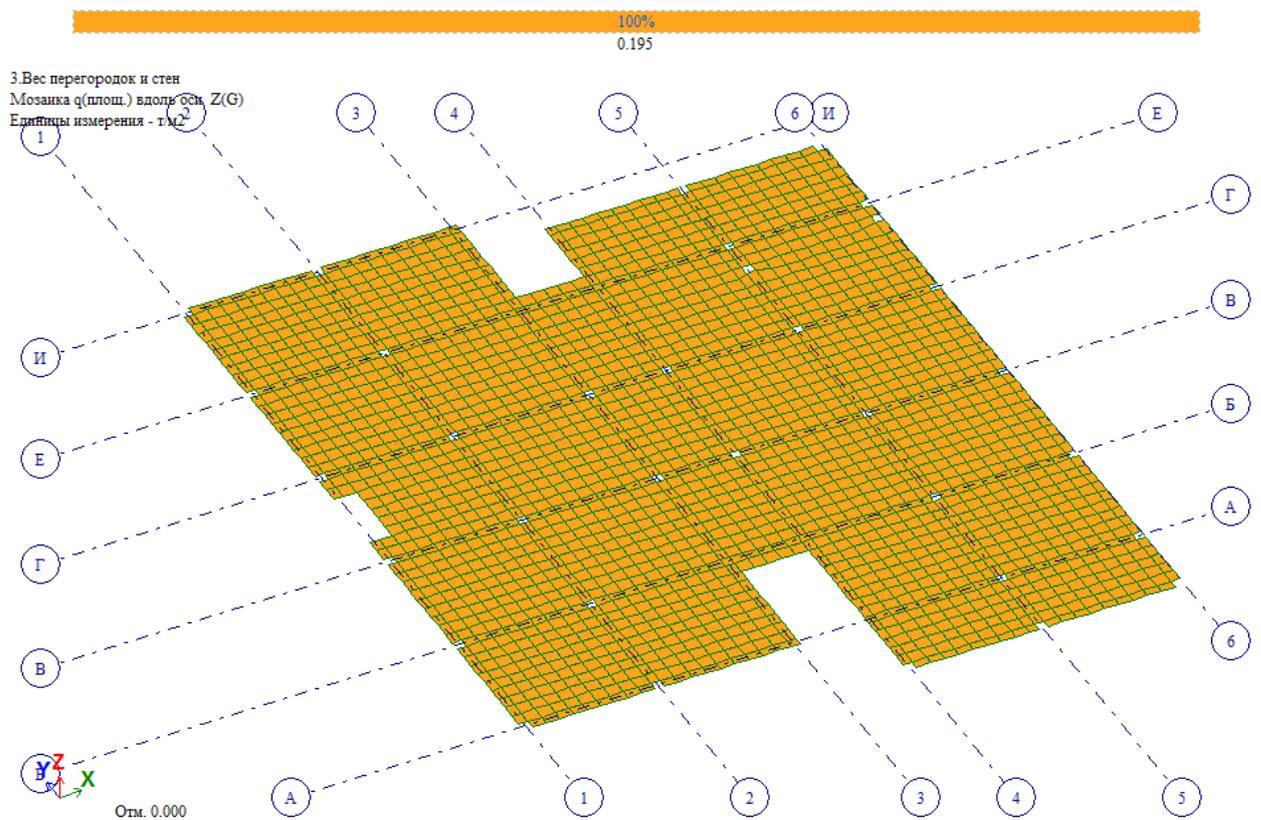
Загрузка 3. Вес перегородок и стен
